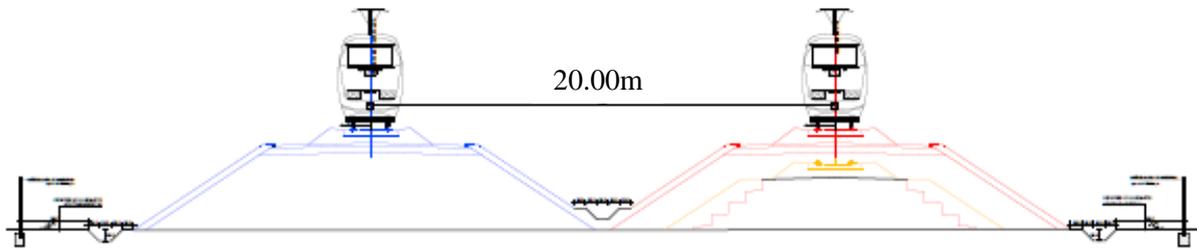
Sezione tipo soluzione 3 in rilevato con raddoppio a 20.00m e innalzamento del piano del ferro - configurazione finale due singoli binari
